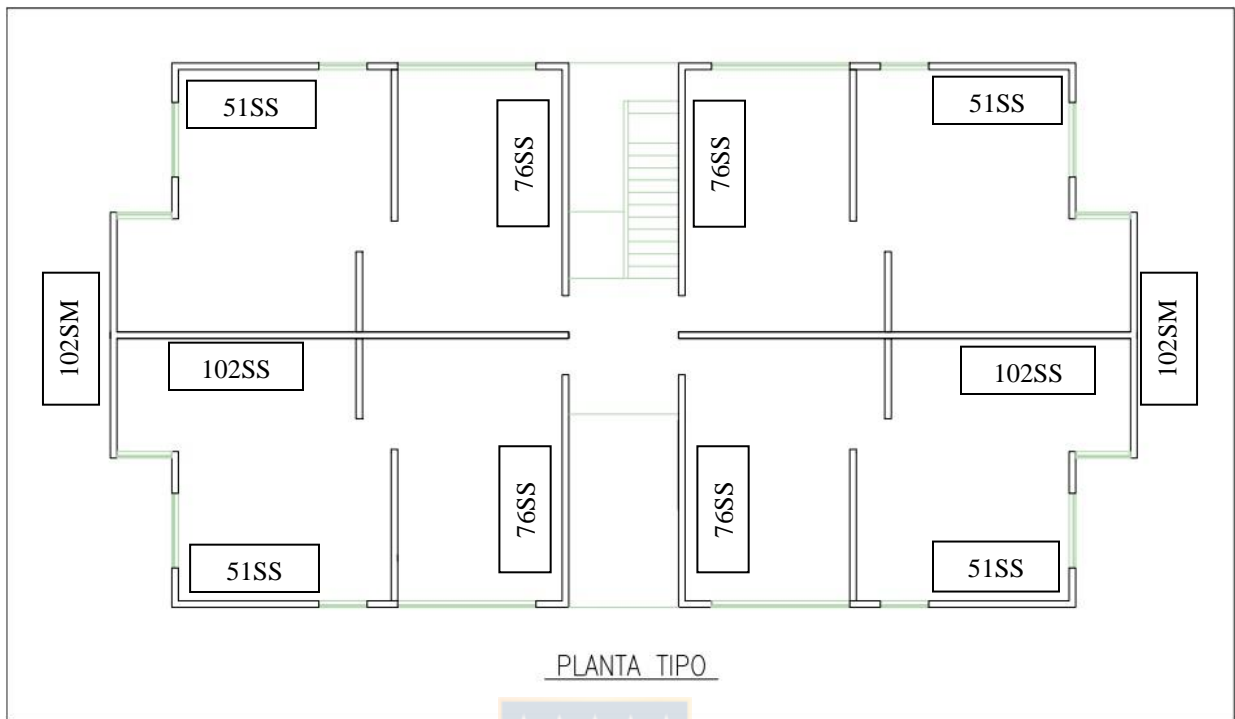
Vista en planta del primer piso modelo completo
